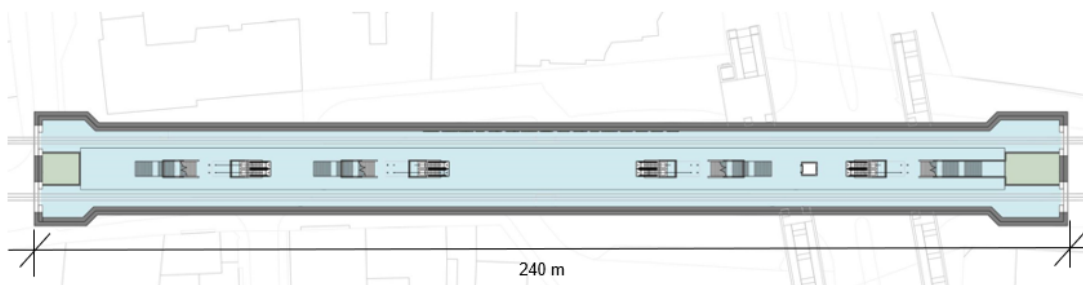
Hp Max-Brauer-Allee Var. 1 – Grundrisse
